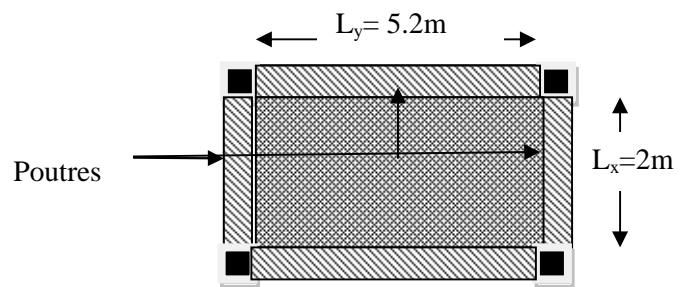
Schéma de dalle sur 4 appuis panneau 2.
